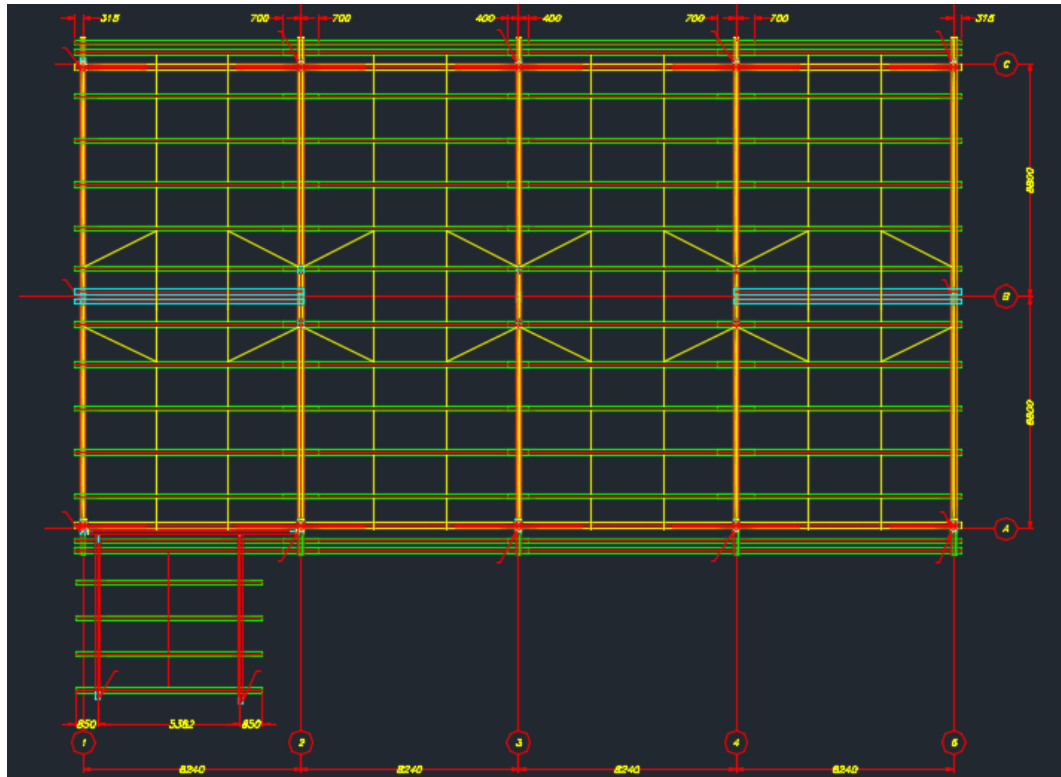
Vista en planta del diseño estructural de la bodega. Fuente: Planos de la bodega
